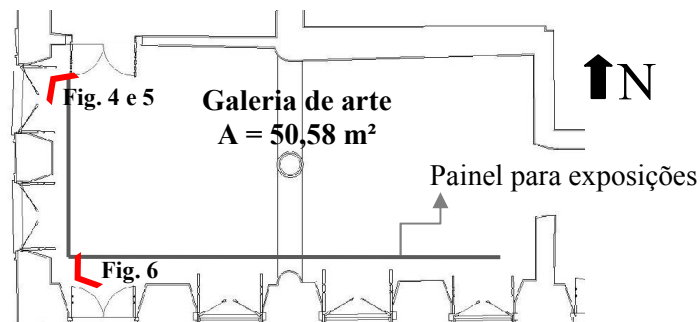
Planta baixa da Galeria de arte - Mapa das Figuras 4, 5 e 6
